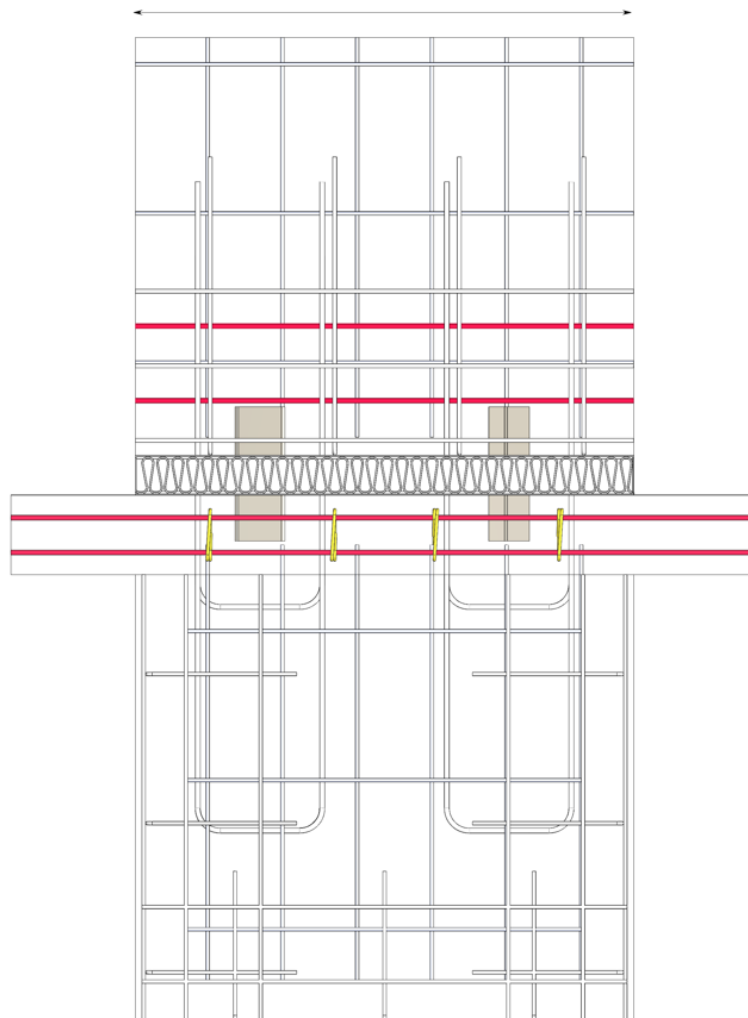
Exemple de ferrailage d'un balcon et prédalle avec suspente servant de chaînage de plancher ⁽¹⁾⁽²⁾
